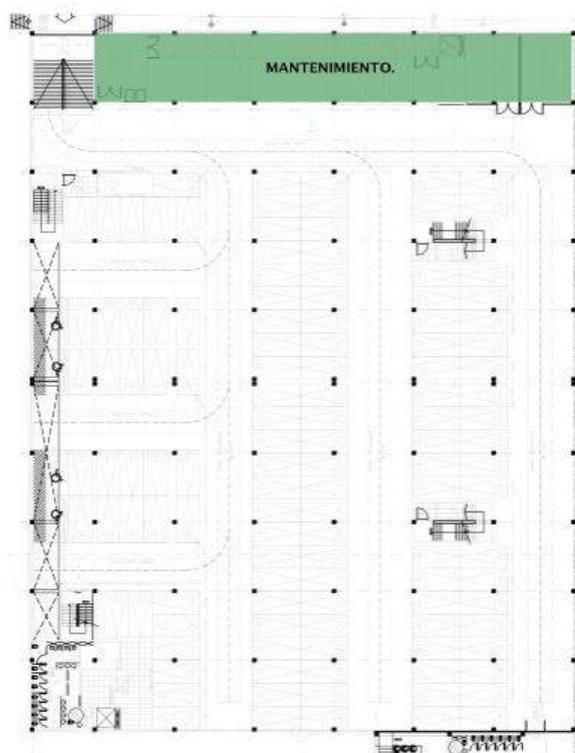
Plan Masa CC Juan Cajas. Subsuelo 1 Planta existente.
